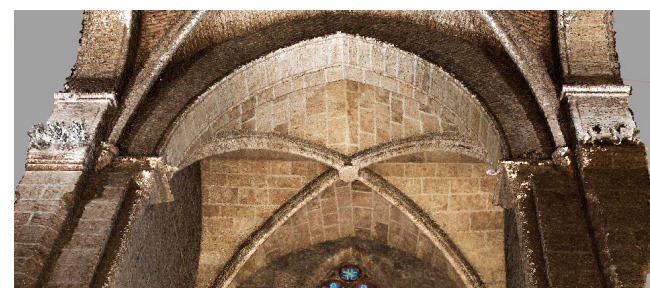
Vistas modelo 3D plementería realizadas con PhotoScan.
